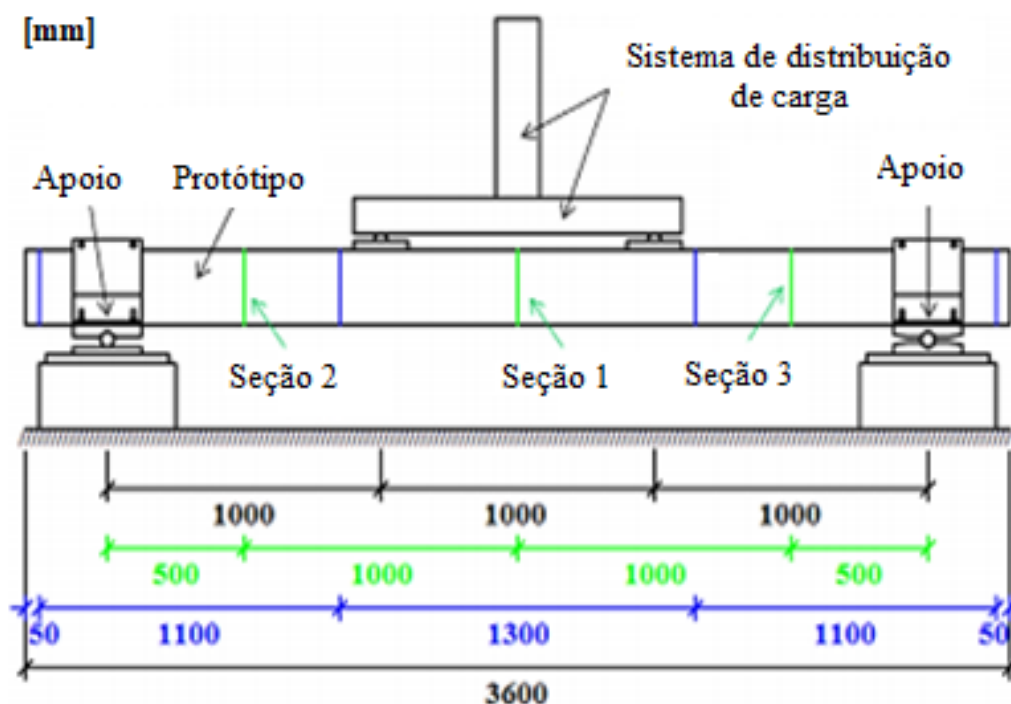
Vista esquemática do ensaio de flexão nas vigas (Laím et al., 2013a)
